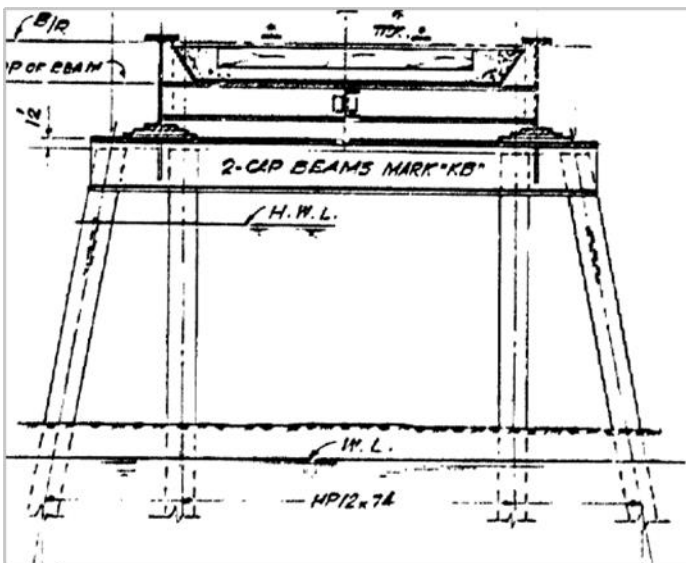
Vue en coupe transversale du pont PM 118.8 Chapais
